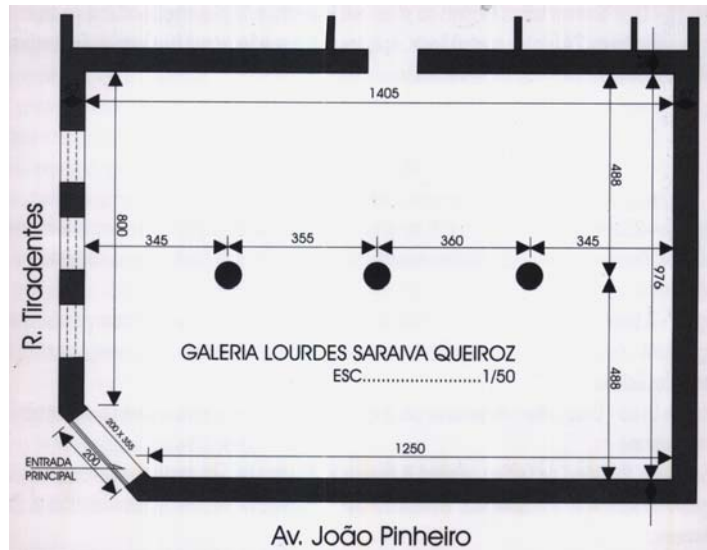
GALERIA Lourdes Saraiva. Planta Baixa. 2006
